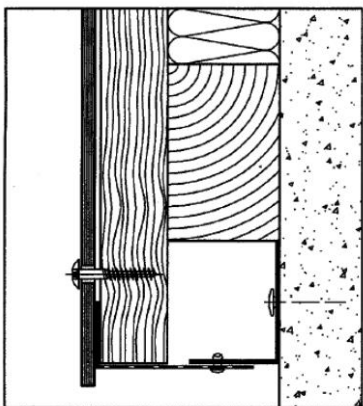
Buitenhoek (horizontale doorsnede)
